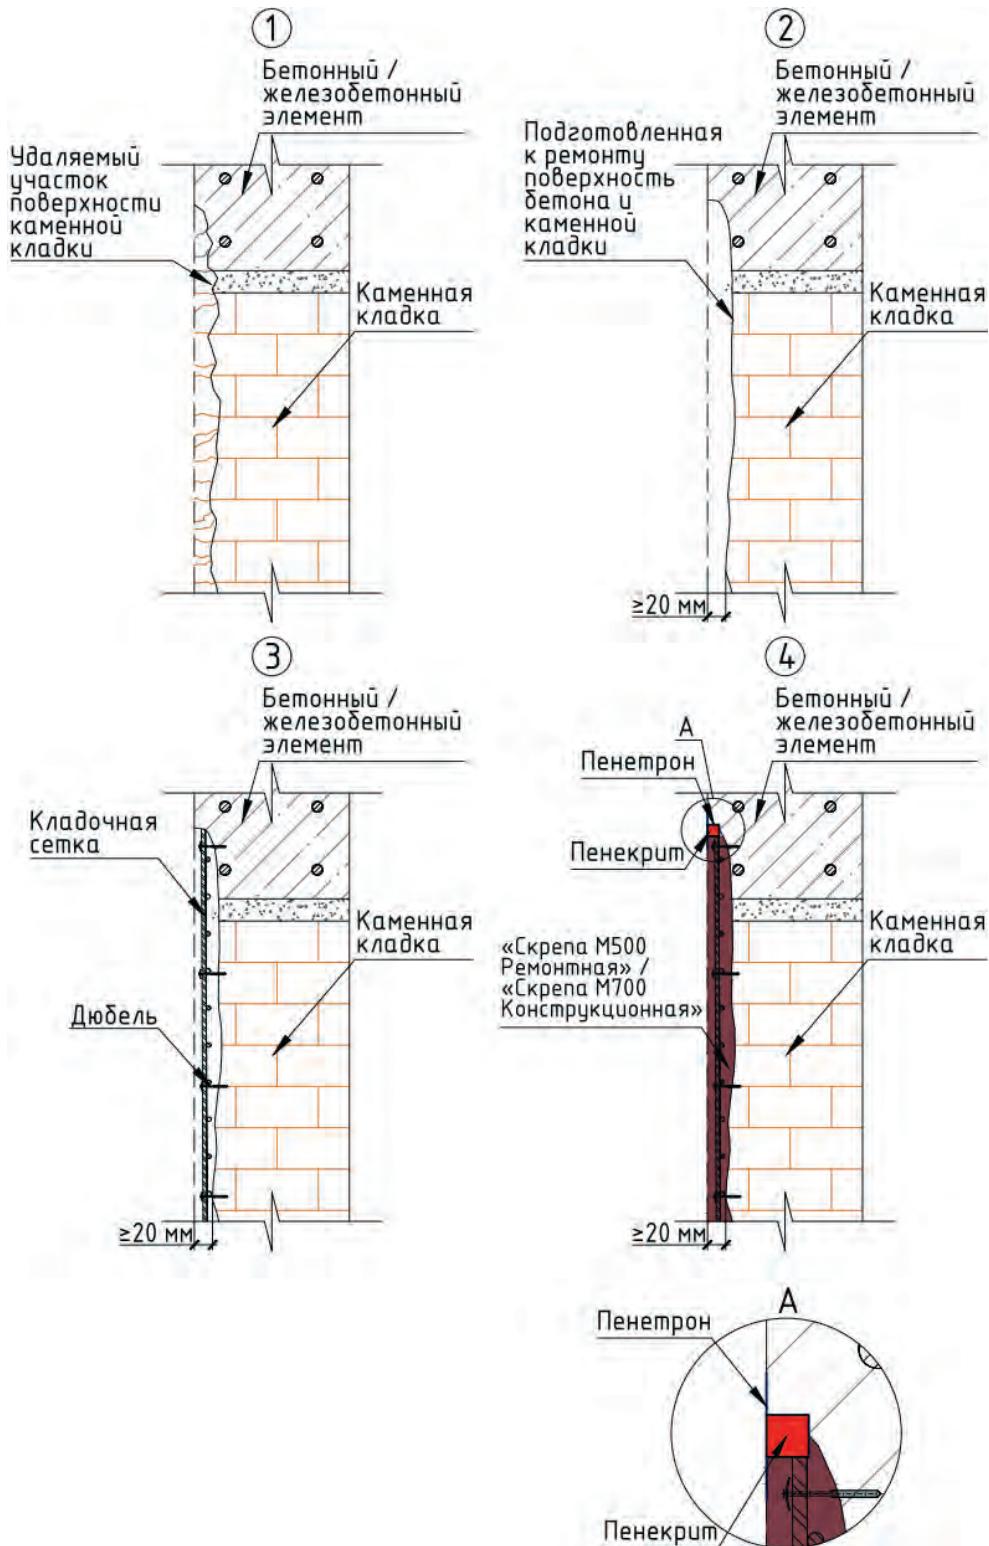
Схема восстановления и гидроизоляции каменной кладки
